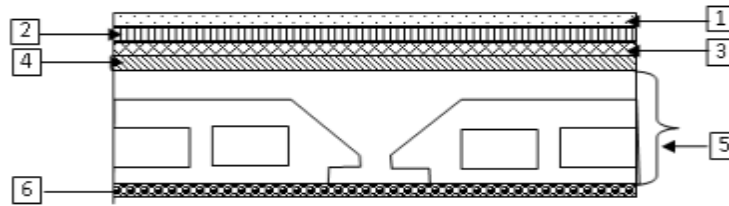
Coupe transversale d'un plancher terrasse inaccessible.
